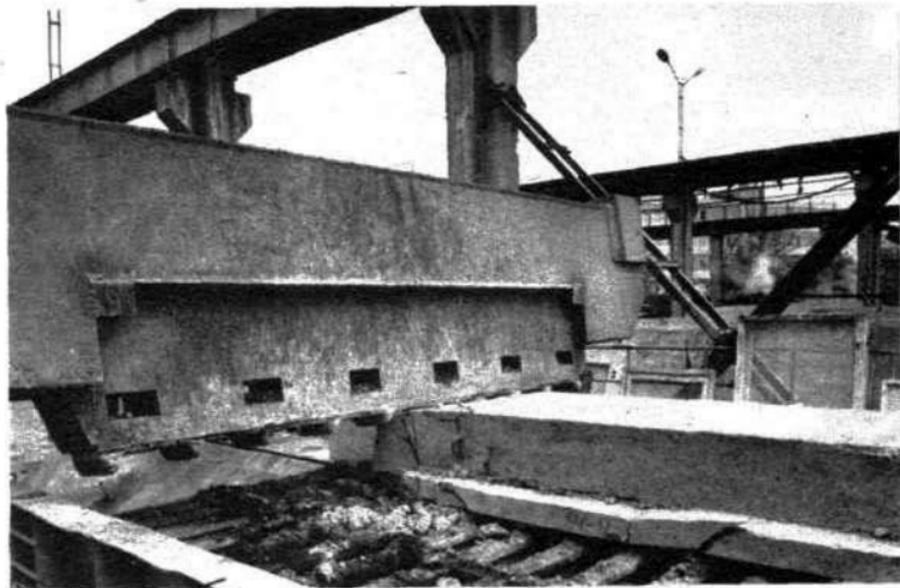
Разрушение некондиционного железобетона рычажным прессом
